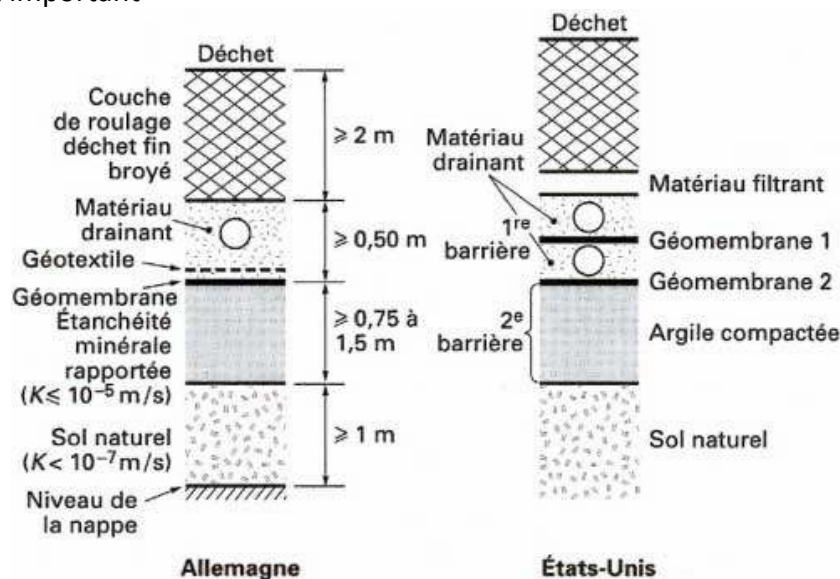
Extraits de Recommandations pour des étanchéités en fond de décharge
